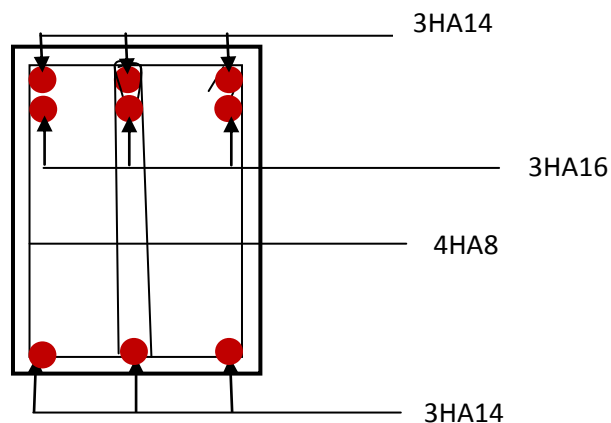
Ferrailage sur appuis d'une poutre principale.
